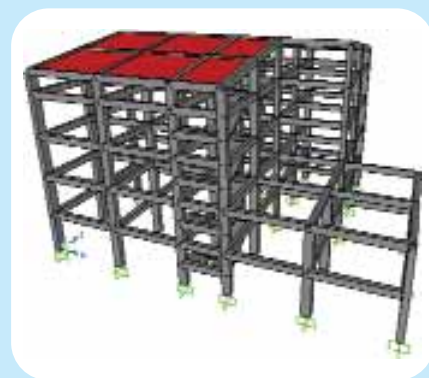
Modello 3D dell'edificio irregolare in pianta ed in elevazione.
